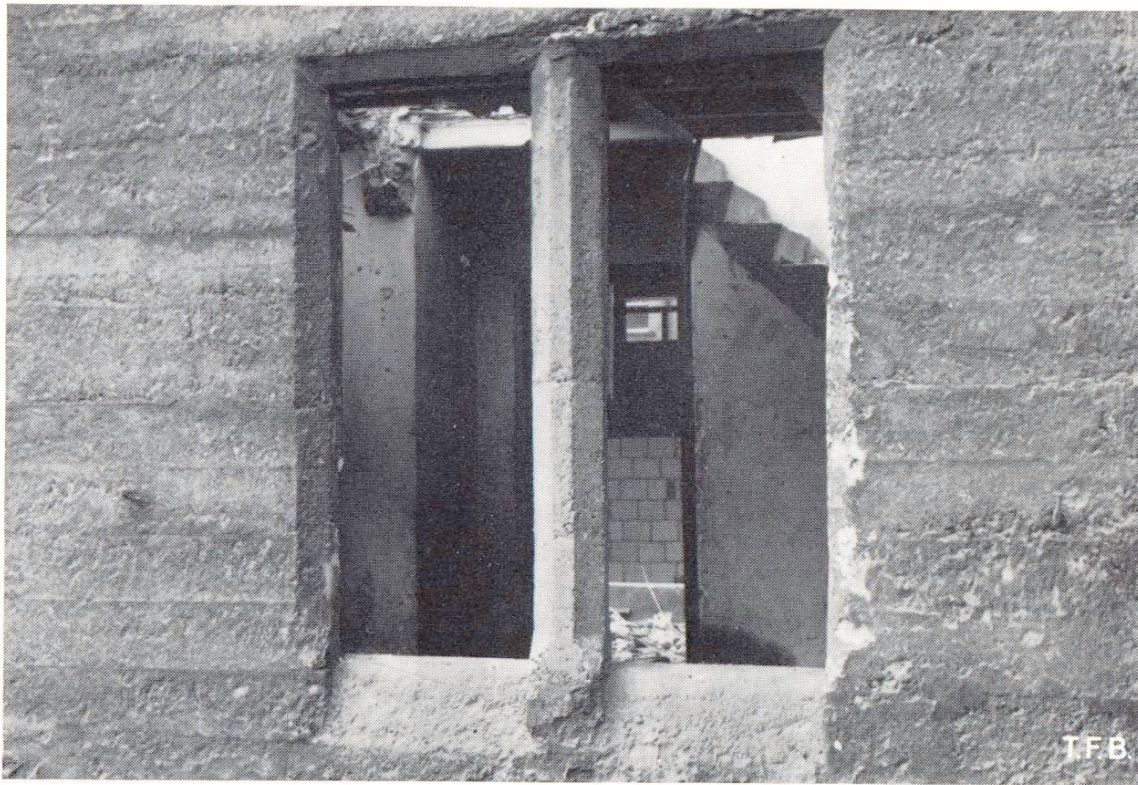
Façade en béton apparent, avec double fenêtre. A l'arrière plan, l'escalier avec marches en béton préfabriqué
